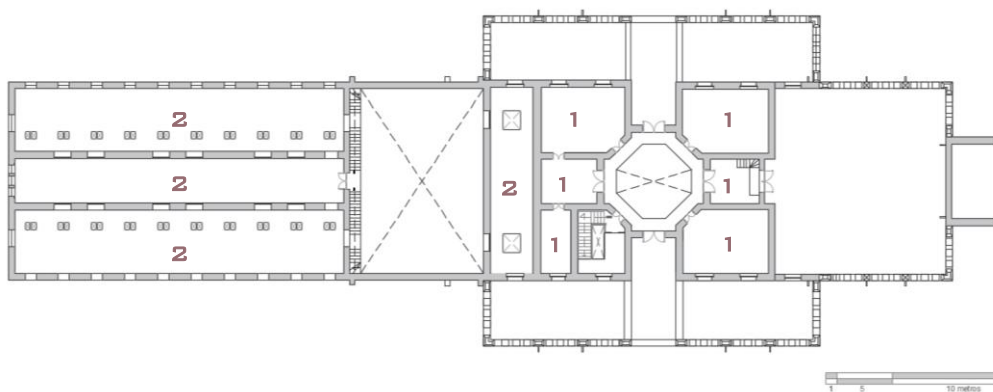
Croquis de ubicación edificio principal planta alta
